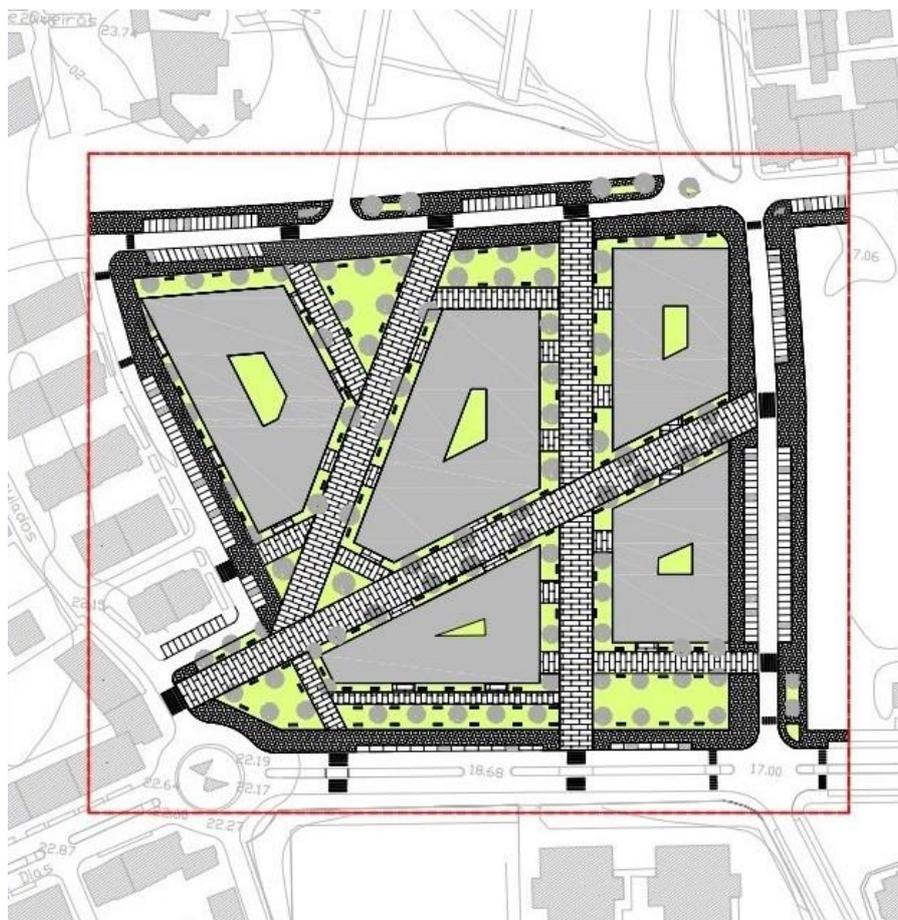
Planta de Implantação sobre proposta a incidir no local
